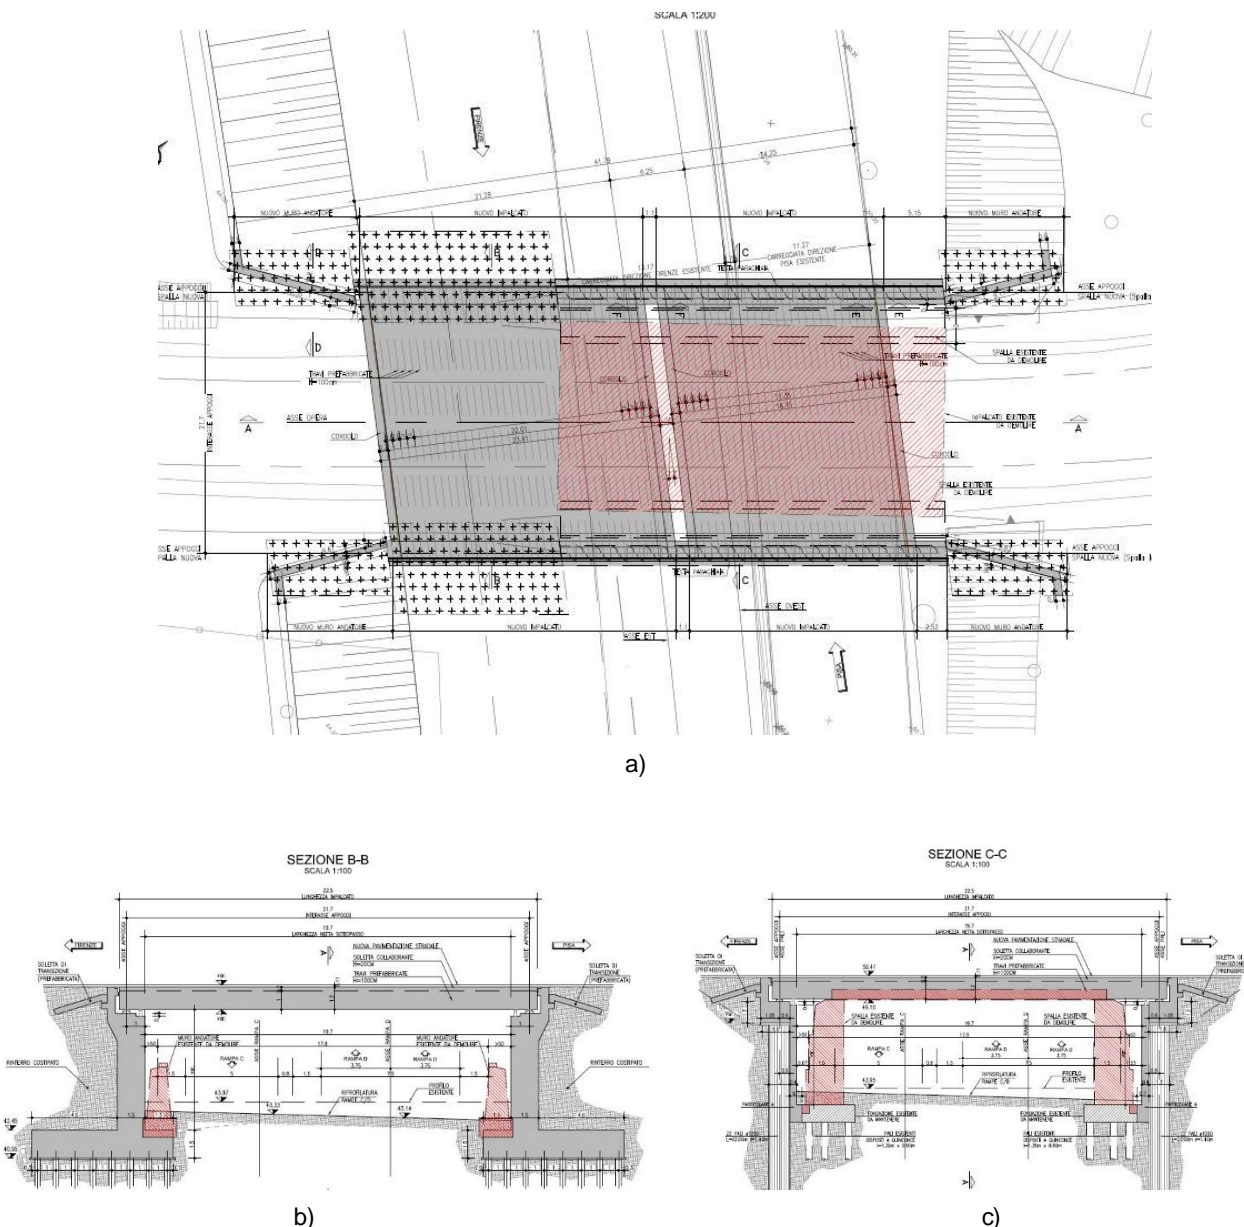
Ampliamento Sottovia: stralcio planimetrico a); profilo longitudinale su nuova struttura b); profilo longitudinale su ampliamento struttura esistente.
